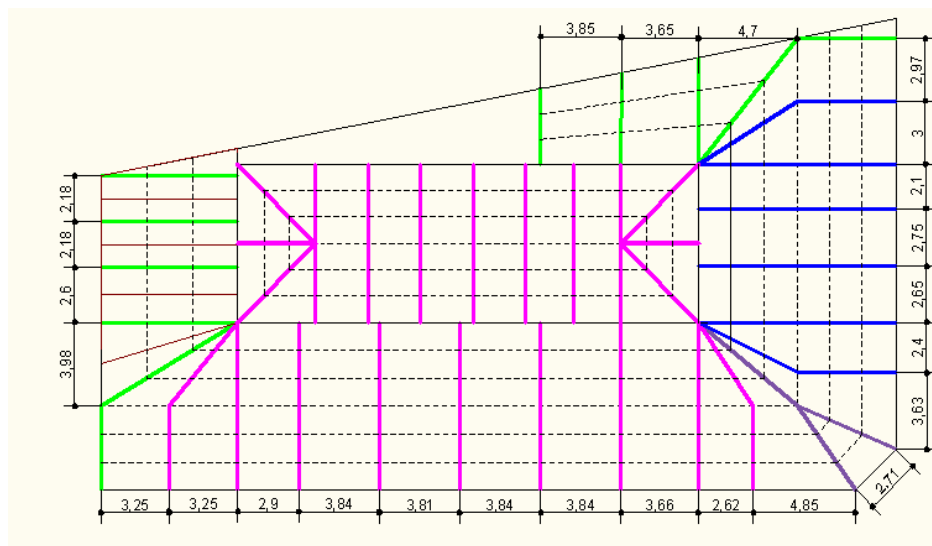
Disposición de las cerchas sobre la estructura de hormigón armado.
